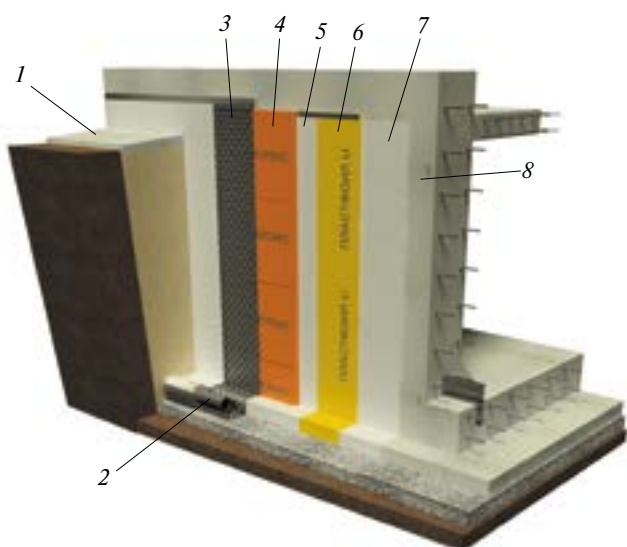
Традиционная система тепло- и гидроизоляции: 1 – грунт обратной засыпки; 2 – дренажная труба; 3 – профилированная мембрана с дренажным слоем из геотекстиля; 4 – теплоизоляция ПЕНОПЛЭКС®; 5 – геотекстиль, 300 г/м²; 6 – гидроизоляция PLASTFOIL® GEO; 7 – геотекстиль, 500 г/м²; 8 – гидроизолируемая конструкция
